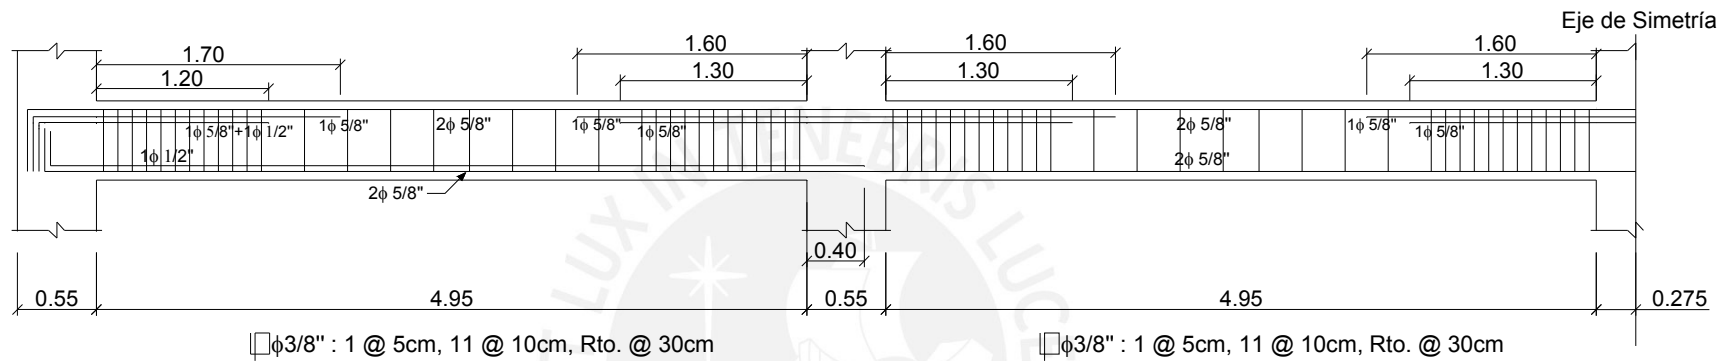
Diseño de viga típica central del 1er y 2do piso
